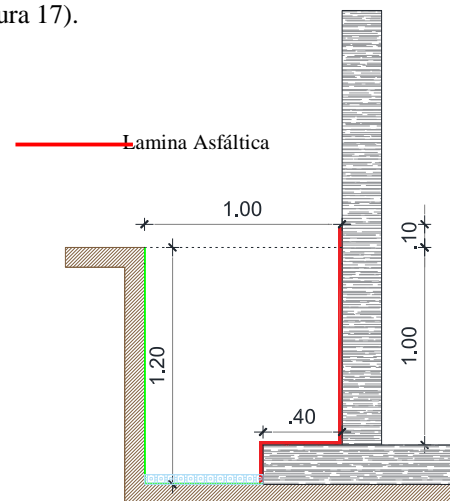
Detalle de Colocación Lámina Asfáltica Súper K en Columna (S/E)
